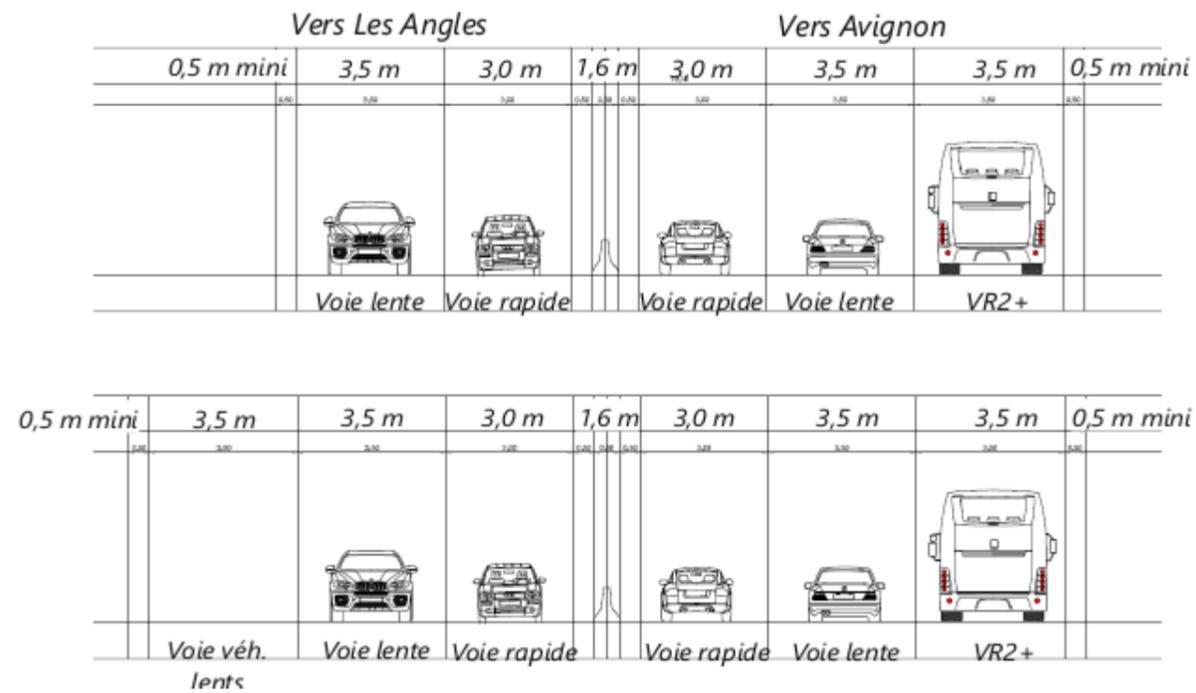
PROFIL EN TRAVERS MINIMAL DE LA SECTION COURANTE
